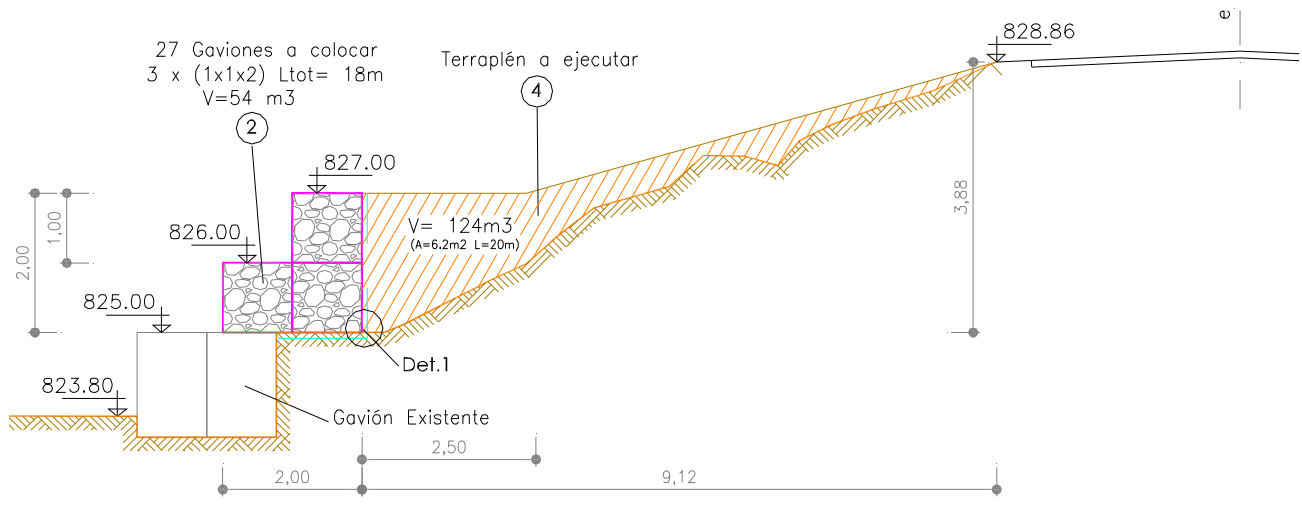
Detalle defensa longitudinal con gaviones, A° El Chanco.
